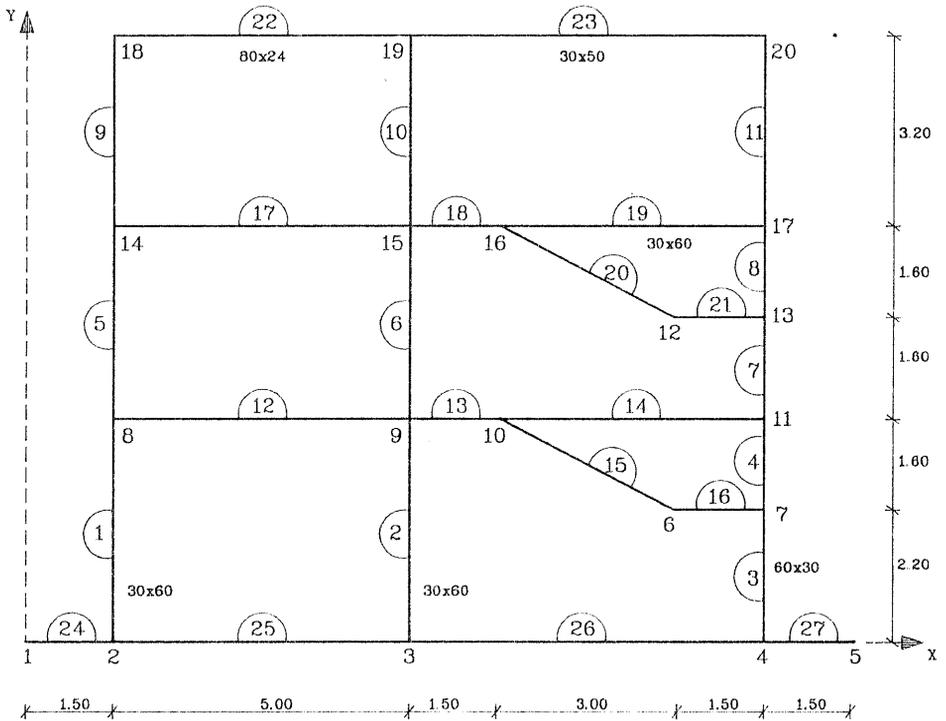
Schema di telaio con trave a ginocchio e trave di fondazione
